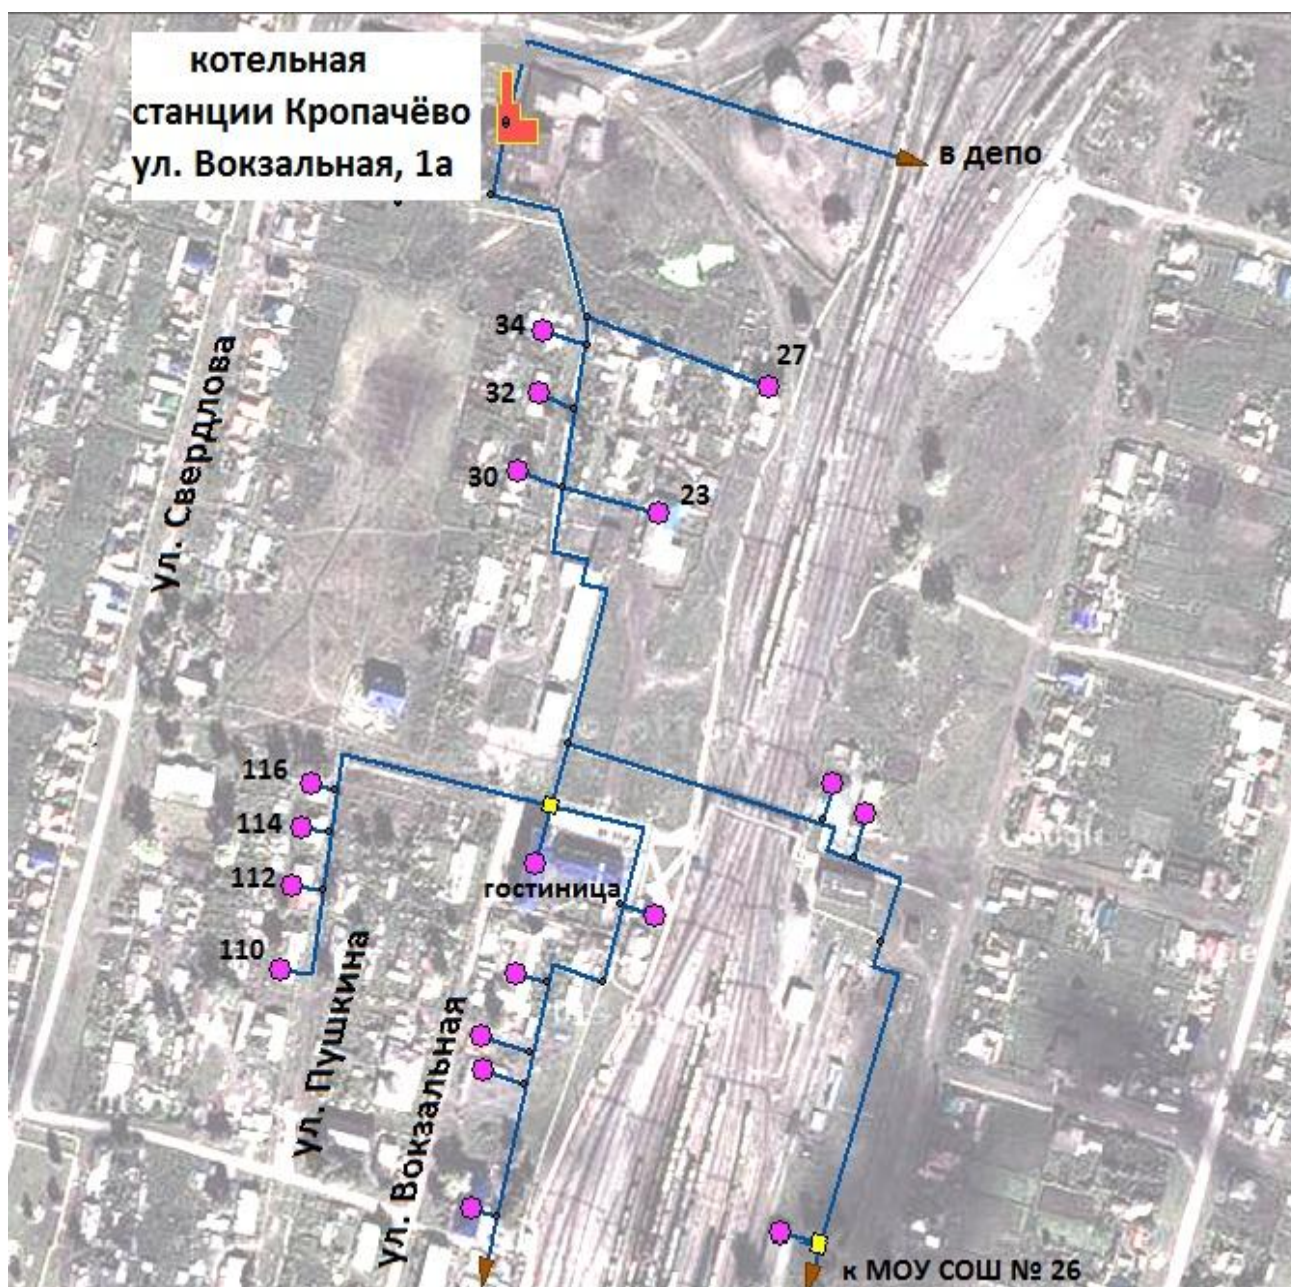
Схема теплоснабжения котельной станции Кропачево, ул. Вокзальная, 1а,(лист 1).
